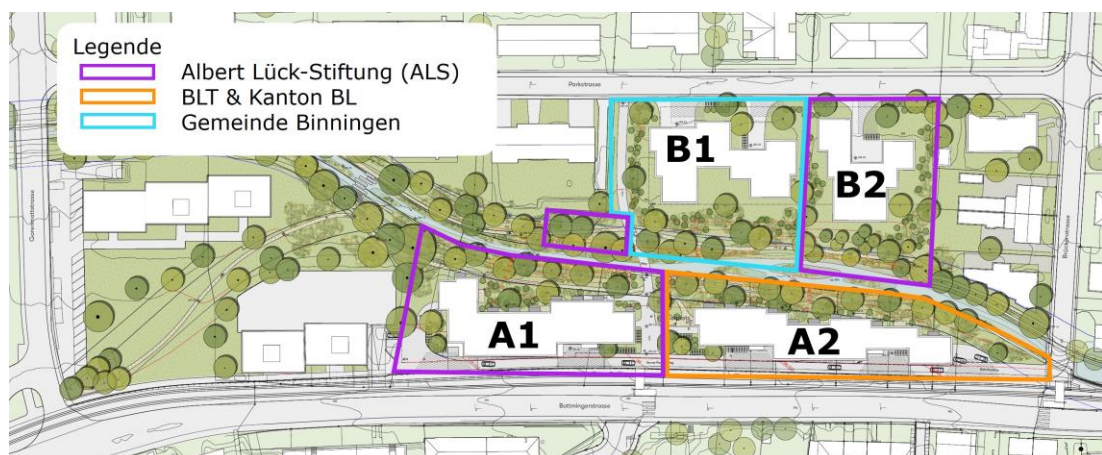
Ausschnitt Quartierplan Spiesshöfli mit den geplanten Gebäuden
